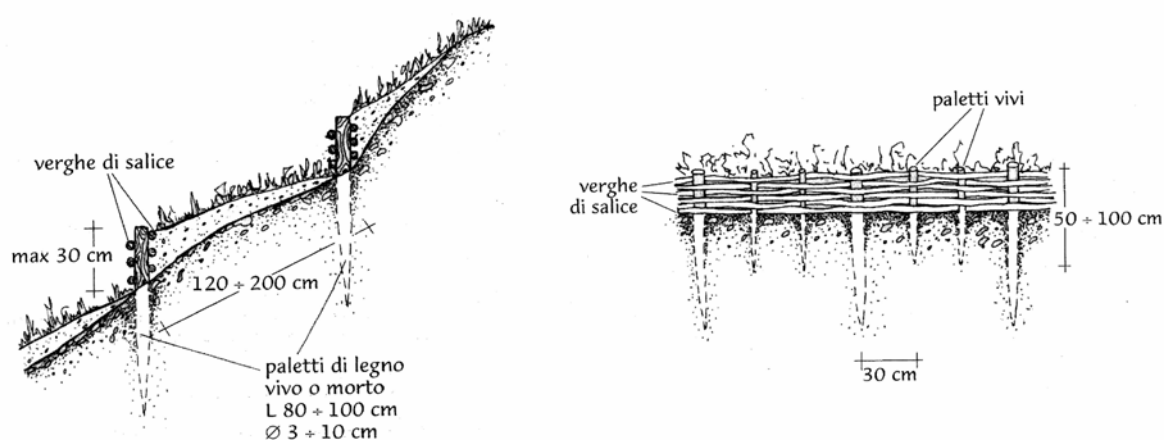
Vista in sezione (a sinistra) e frontale (a destra) di una vimate (da PROVINCIA DI TERNI, 2003; modificata) -
